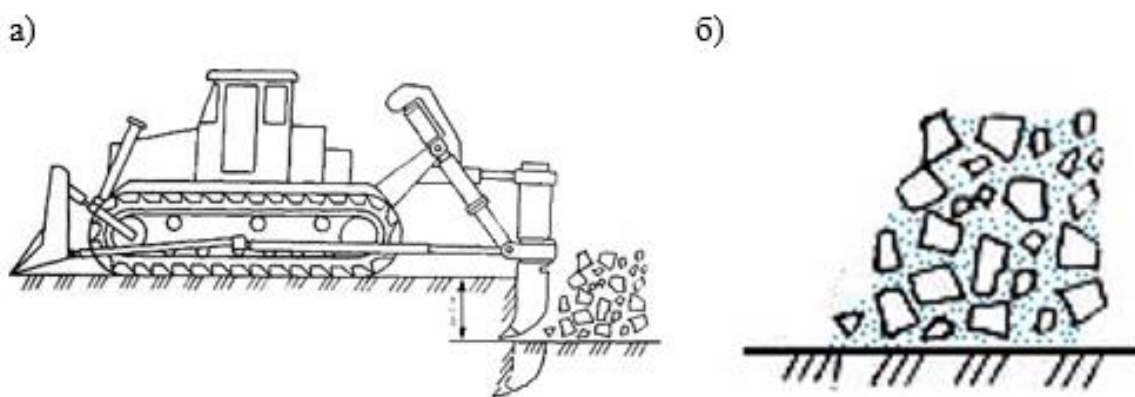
Схема рыхления грунта для повышения водопоглощения верхнего слоя грунта породного отвала: а) схема рыхления на глубину до 1 м; б) заполнение влагой рыхлой породы
